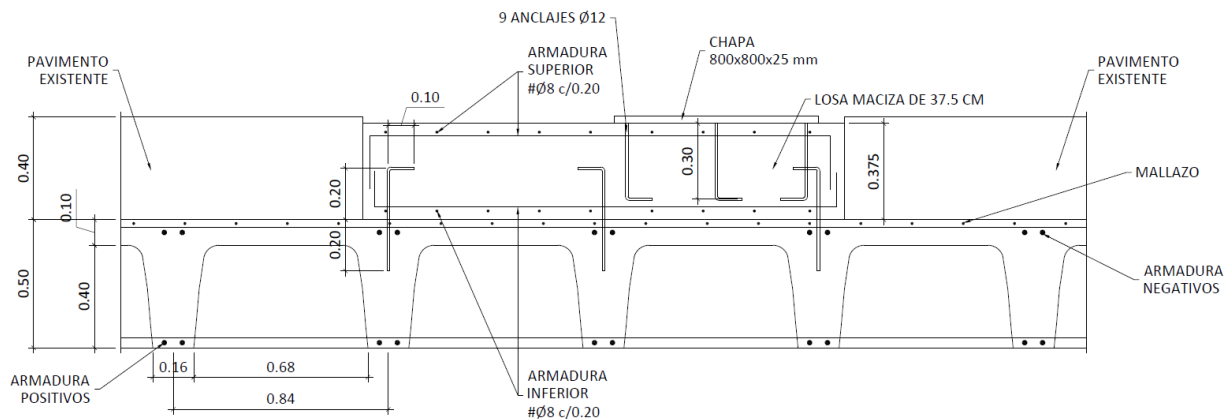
Detalle conexión forjado existente con zapatas. Fuente: Proyecto instalación de parque Multiaventura sobre forjado del centro comercial LAGOH en Sevilla
